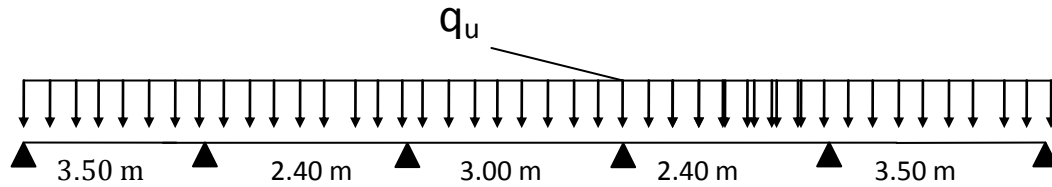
Schéma statique de la poutrelle RDC type 2.
